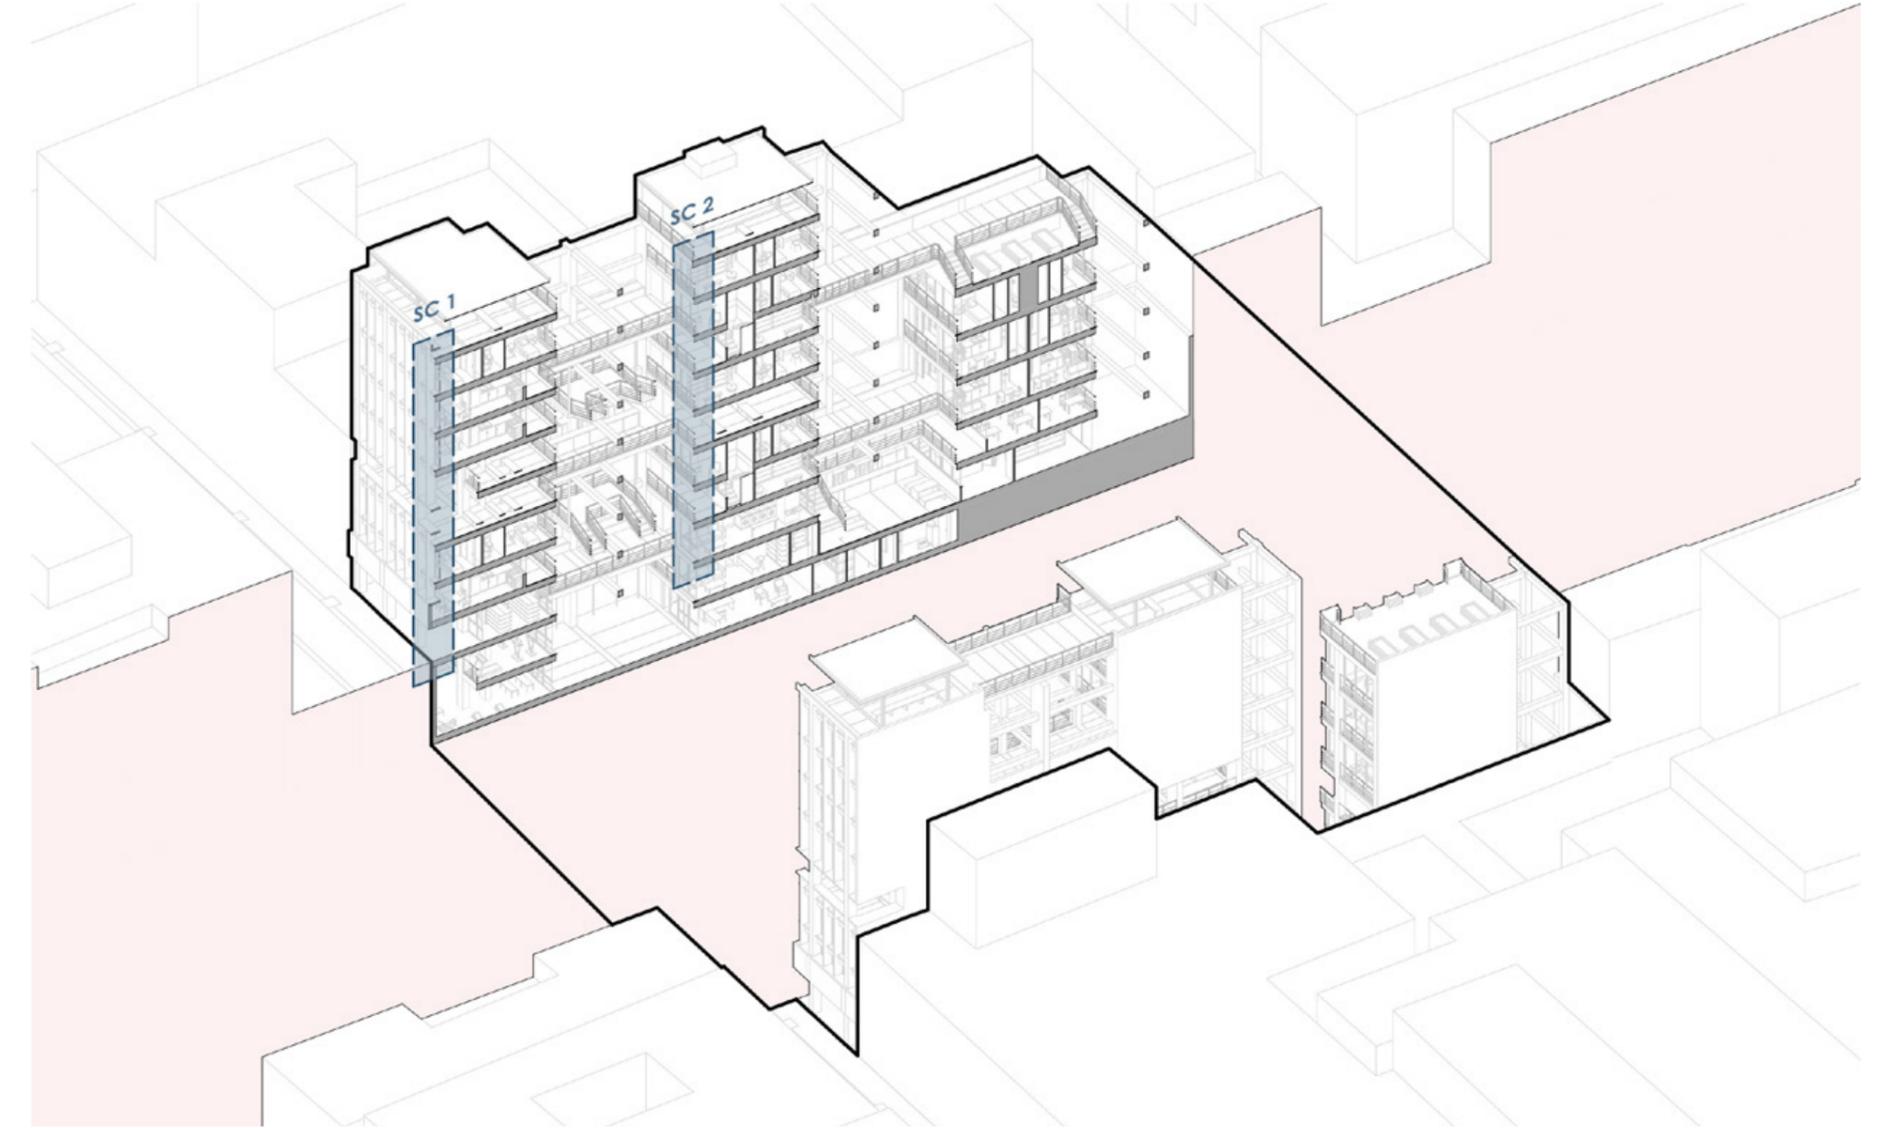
Ubicación de las secciones constructivas de la propuesta de proyecto. Fuente: Elaboración propia.
